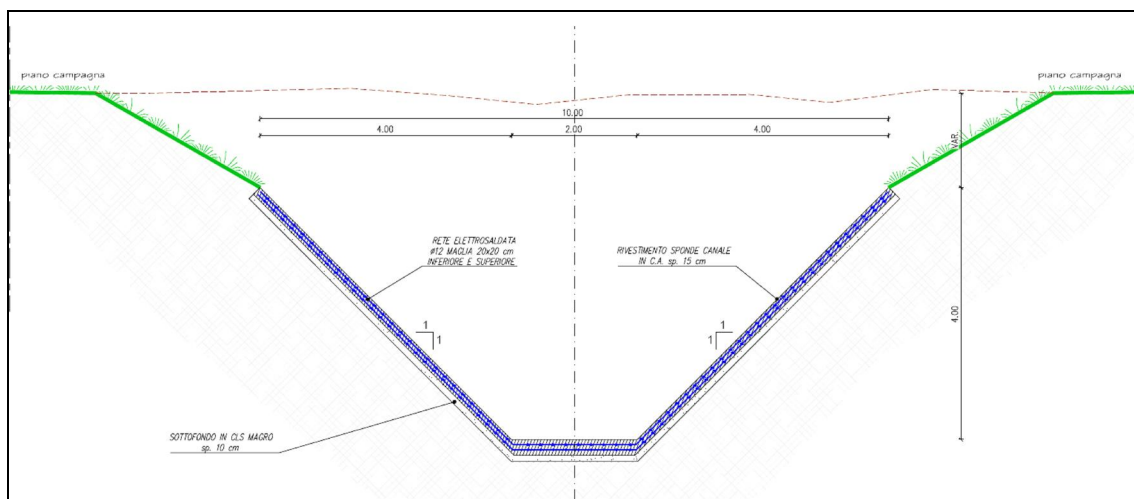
Sezione trapezia del canale di alimentazione dell'invaso
